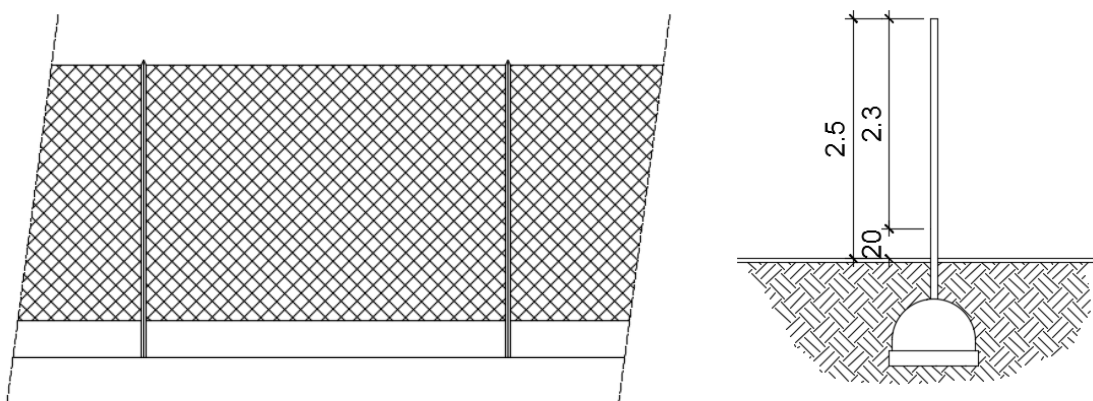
1. Cerramiento perimetral de la depuradora. Vista en alzado y perfil.
